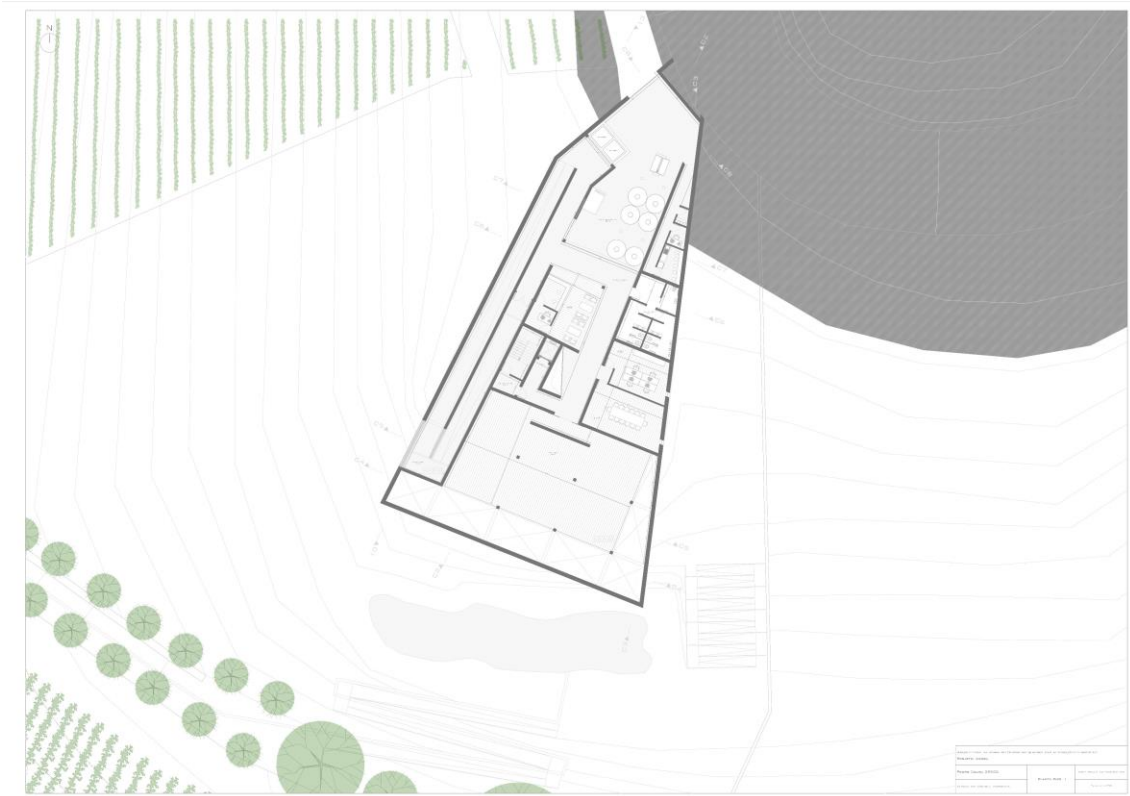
Planta piso -1 (cota 215.00) - Autor
